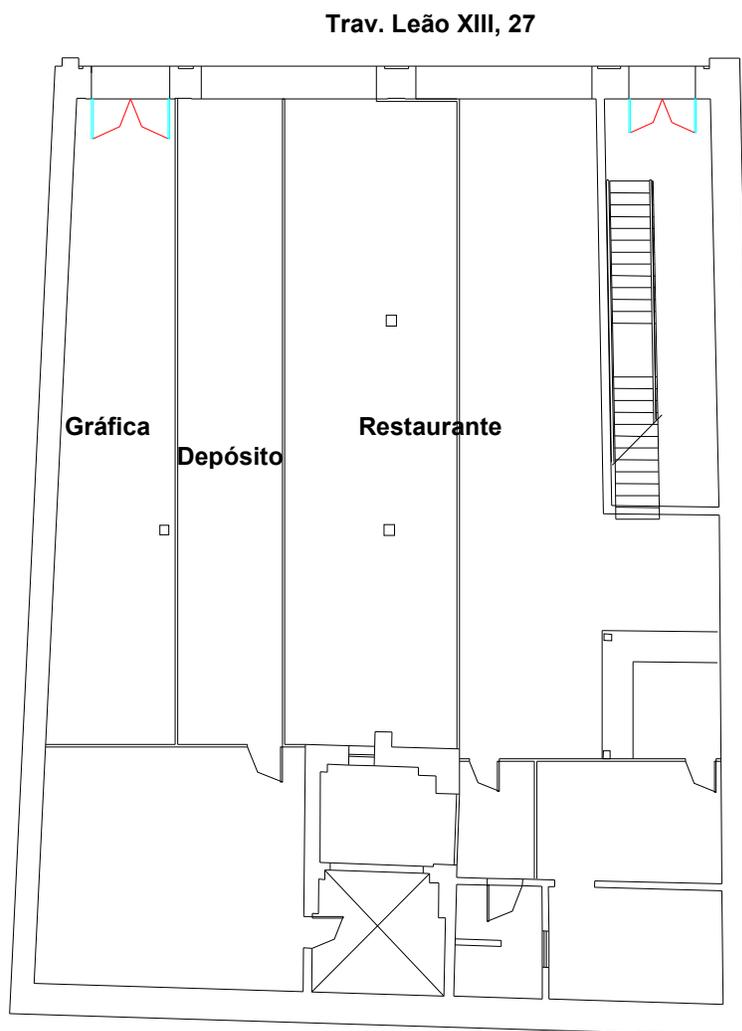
Levantamento arquitetônico do pavimentos térreo.
